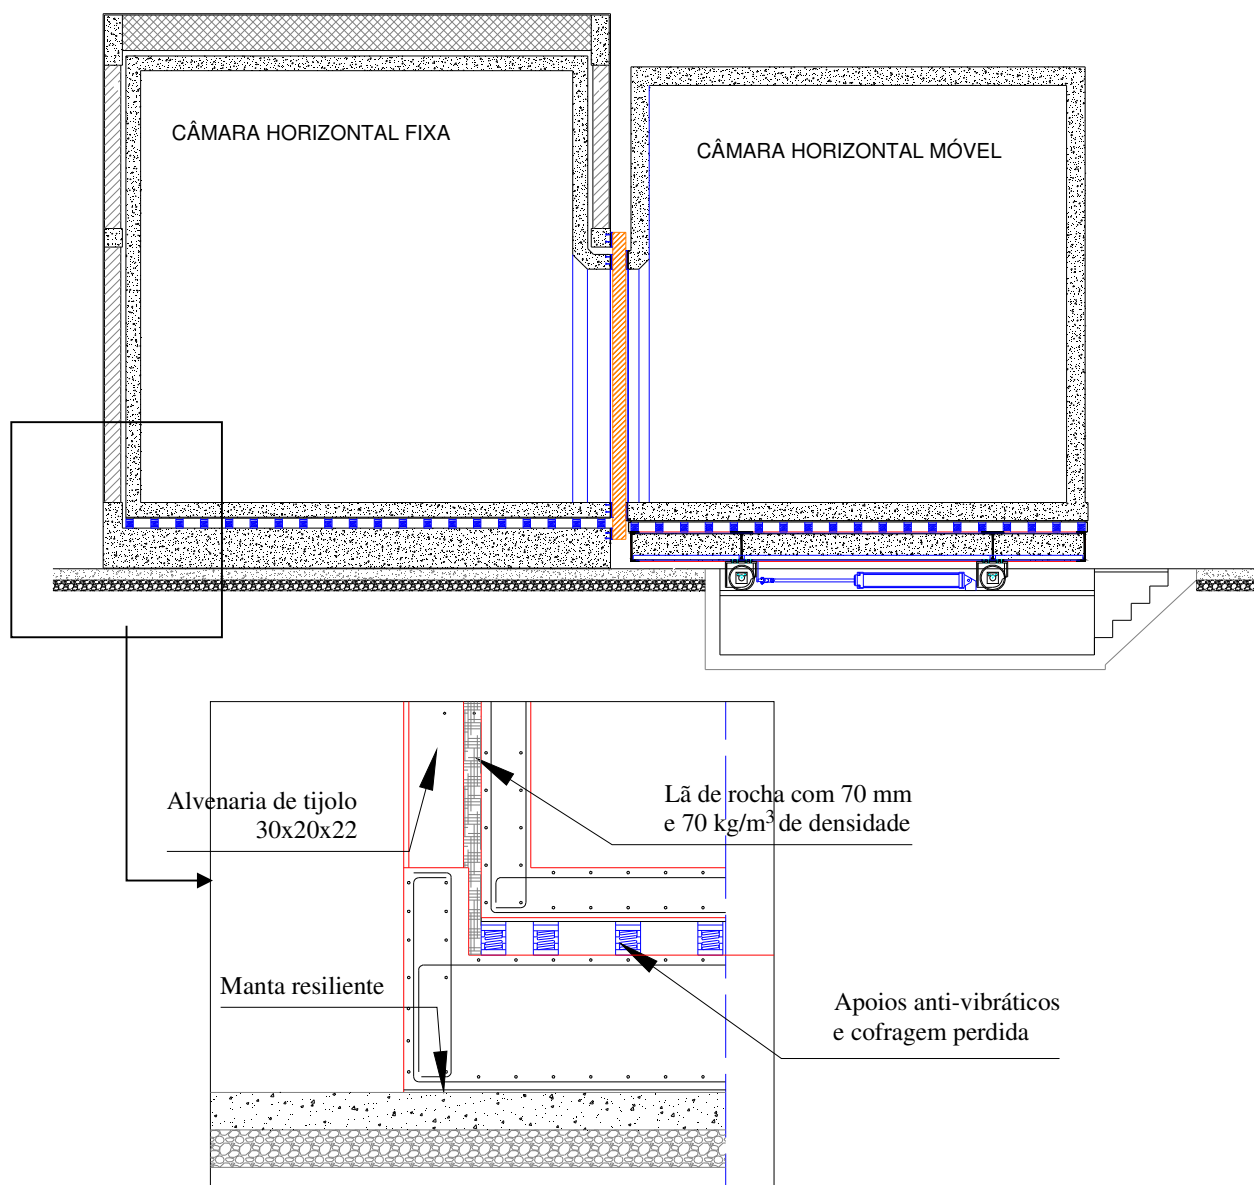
Câmaras horizontais : esquema em corte longitudinal; pormenorização do sistema de isolamento de vibrações na base da câmara horizontal fixa.
